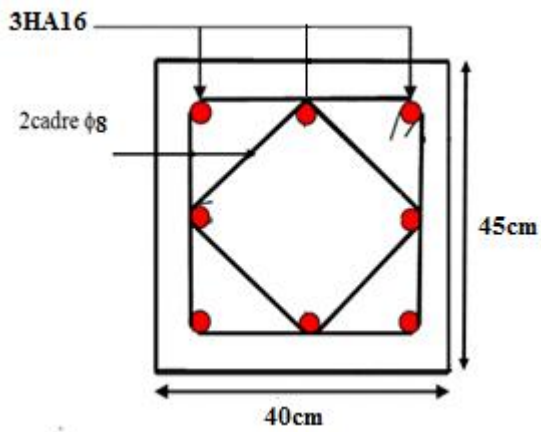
Schéma de ferrailage des poteaux 3^{ème} et 4^{ème} étage.
